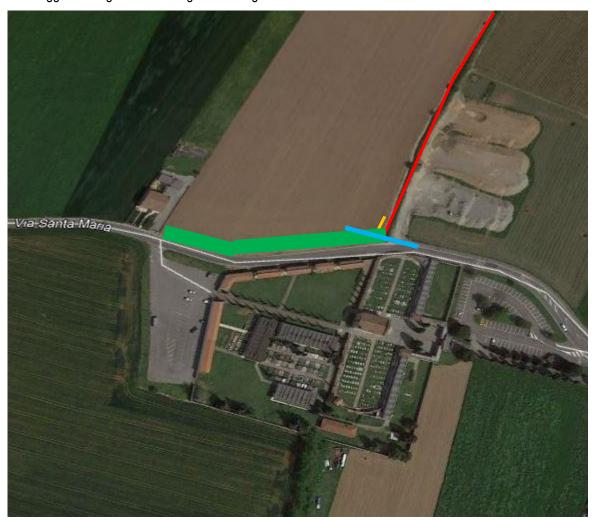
rappresentazione schematica intervento di mitigazione del rischio idraulico:
